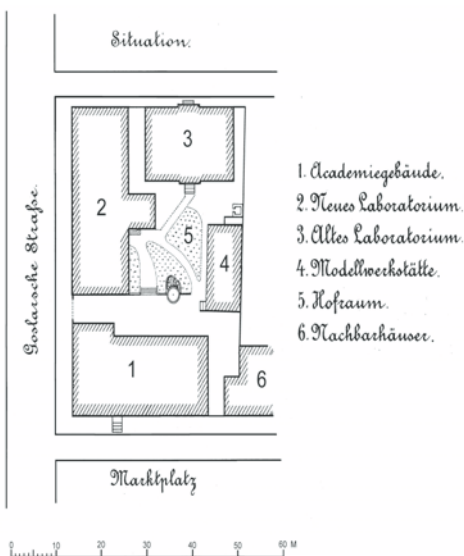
Lageplan der Gebäude der Bergakademie (um 1880).
